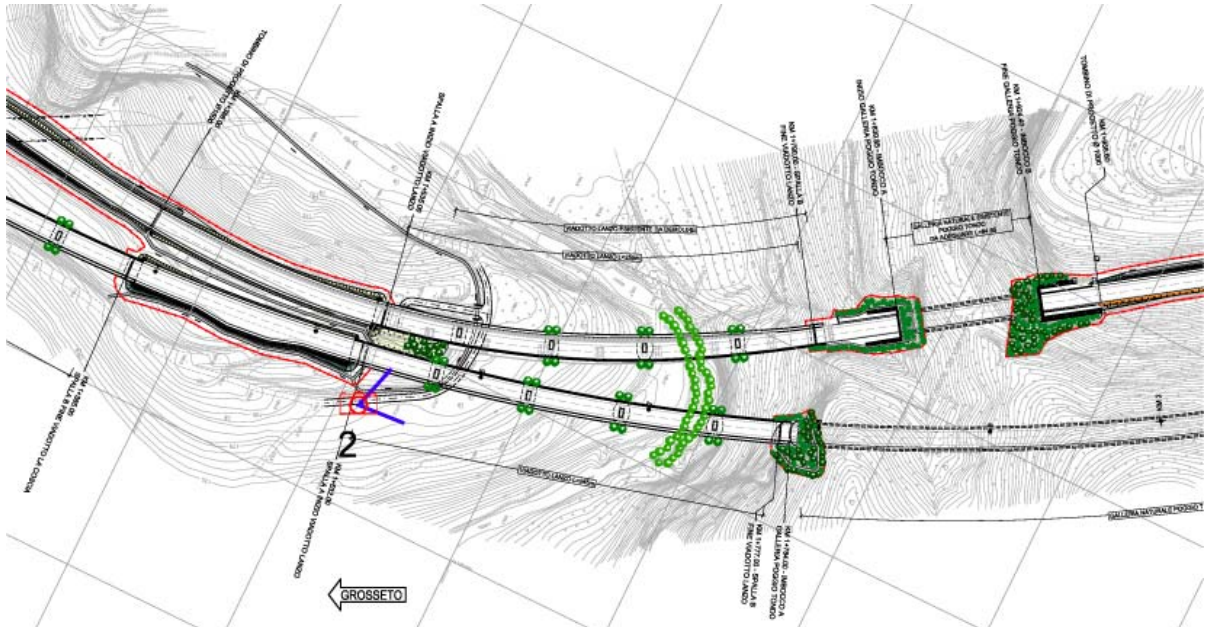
Vista 2 – Planimetria con mitigazioni e punto di vista fotografico
